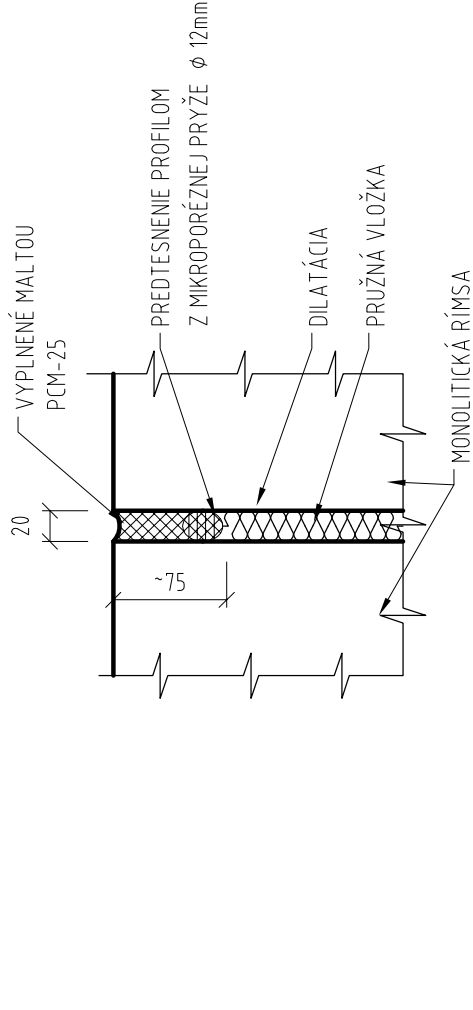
DETAIL TESNIACEJ ZÁLIEVKY MEDZI LÍČNYM PREFABRIKÁTOM A MONOLITICKOU RÍMSOU
